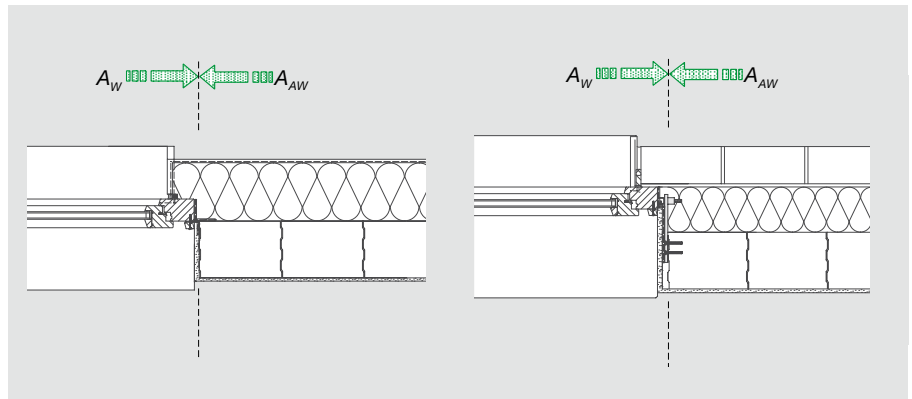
Ermittlung des lichten Rohbaumaßes bei Fensteröffnungen (stumpfer Anschlag, zweischaliges Mauerwerk, mit Innenanschlag); A_W = Fensterfläche, A_{AW} = Fläche Außenwand
